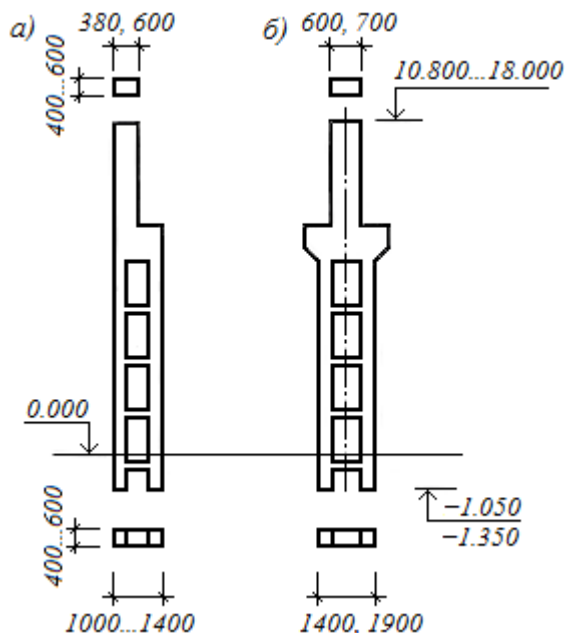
Збірні двогілкові залізобетонні колони для будівель з мостовими кранами: а – крайніх рядів; б – середніх рядів
